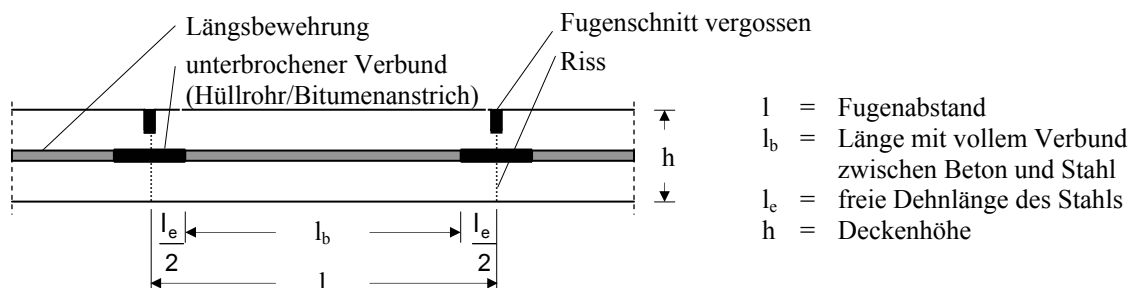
Durchgehend bewehrte Betondecke mit gesteuerter Rissbildung und elastischer Plattenkopplung /4/
